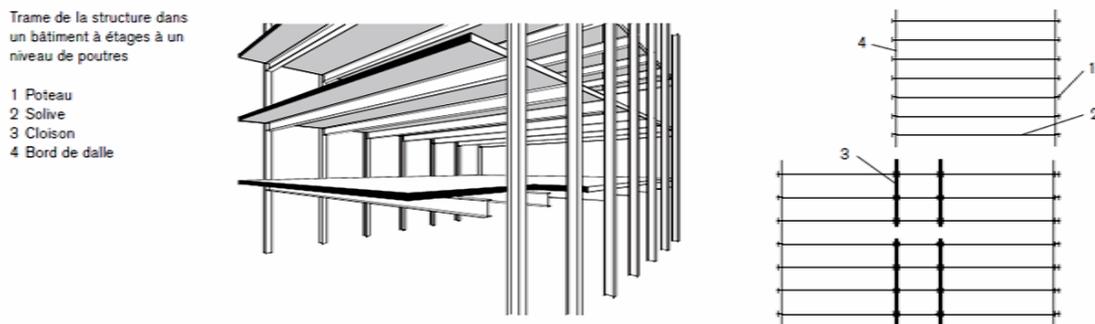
Schéma de trame de la structure dans un bâtiment à un niveau de poutre.
